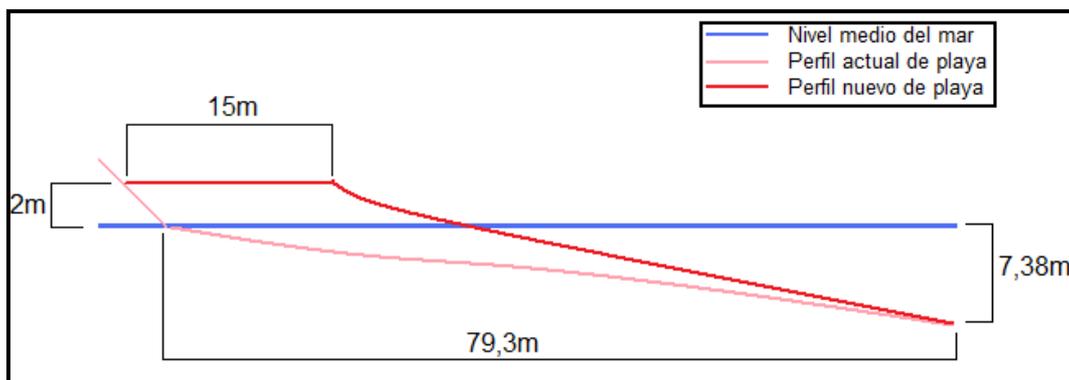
Perfil de equilibrio de las dos playas regeneradas en Alcanar.
